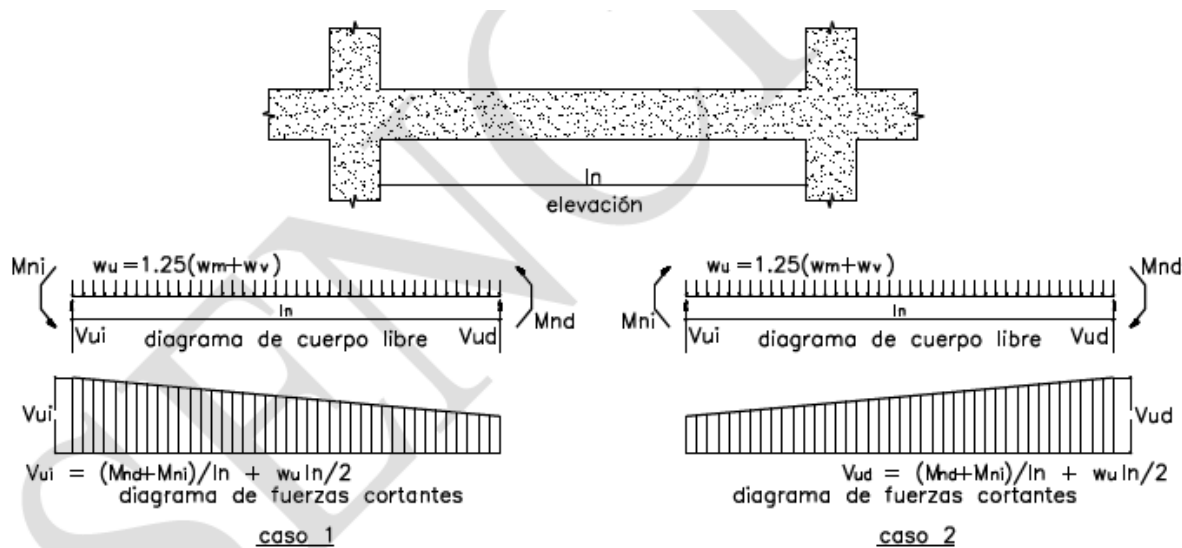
Esquema de diseño por capacidad para vigas en sistema de muros (Ministerio de Vivienda, 2009)
